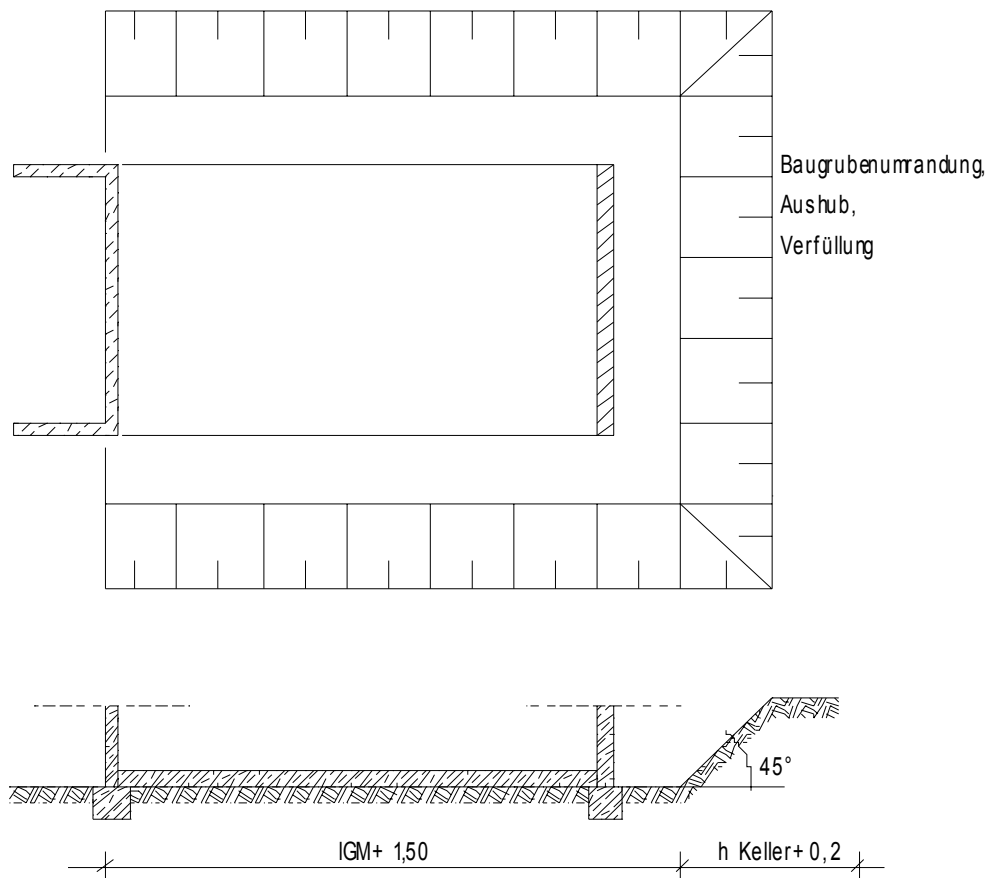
Grundriss und Längsschnitt Baugrube
